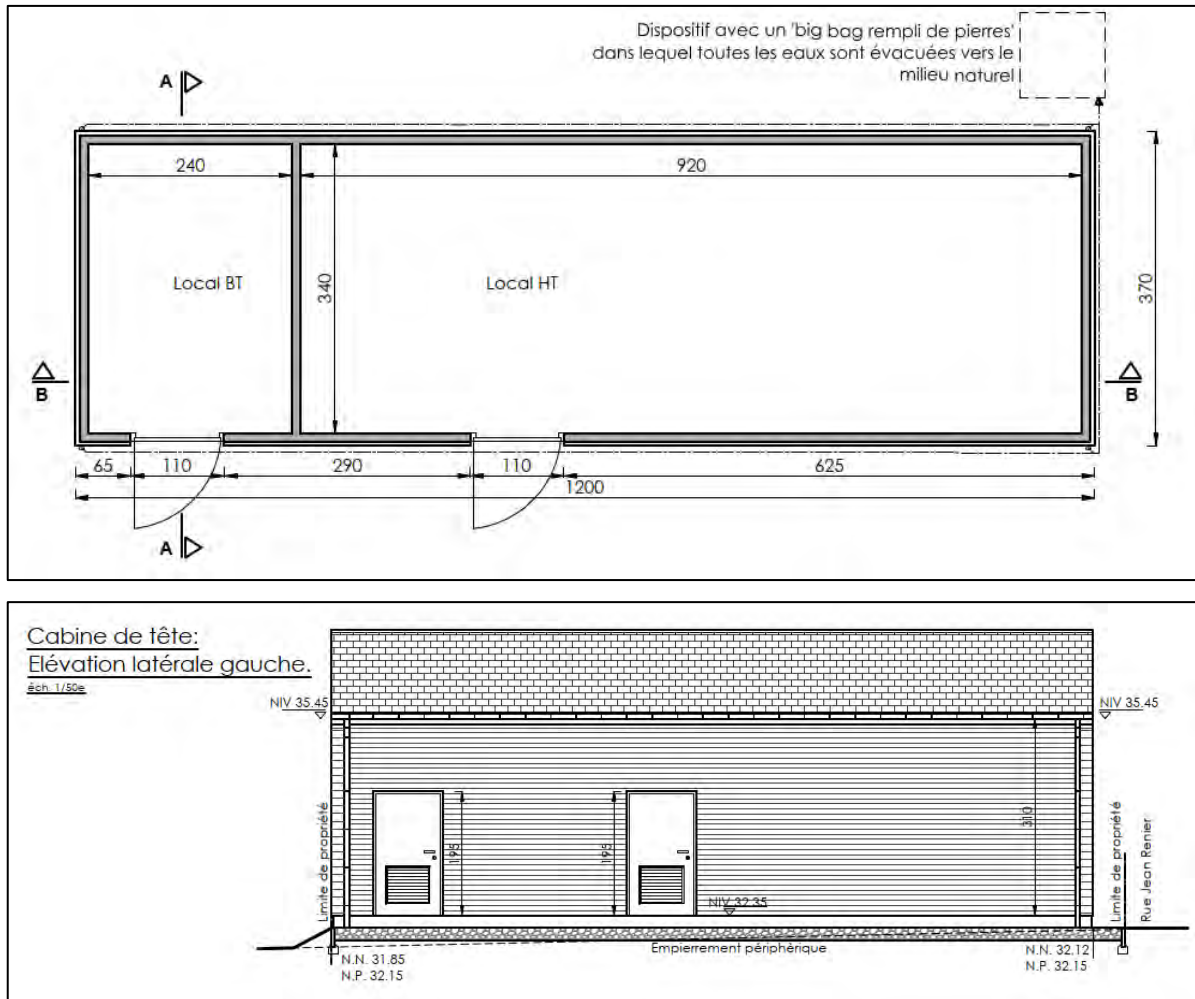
Vue en plan et vues en élévation de la cabine de tête (source : Plans de la demande de permis, 2026).
